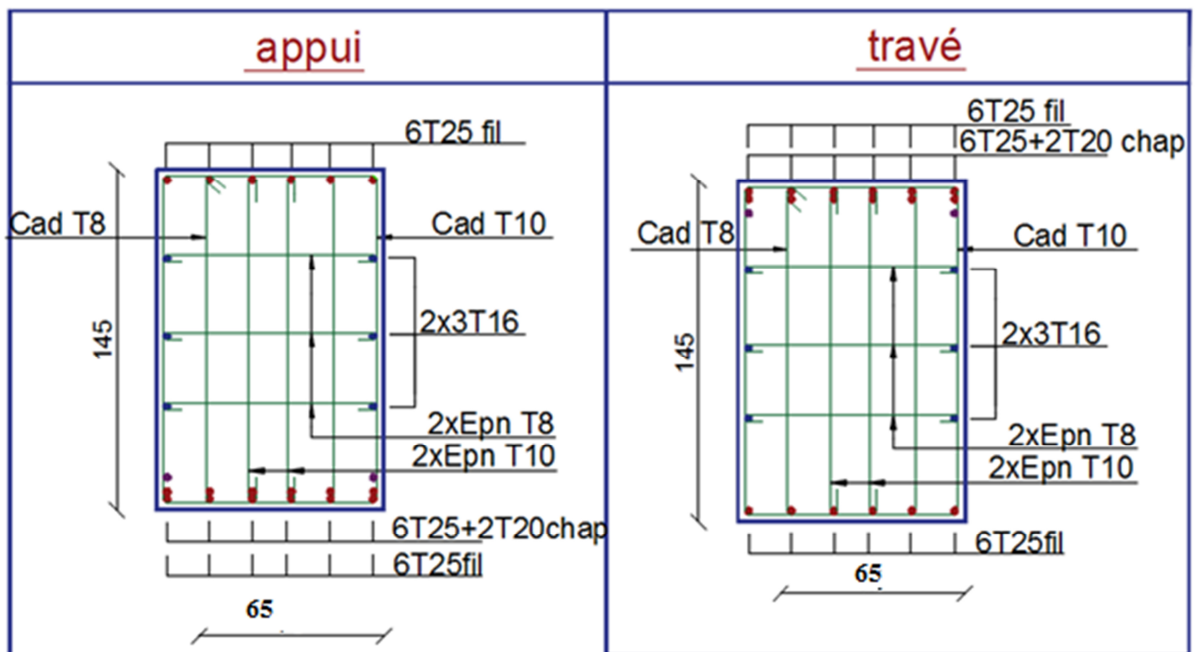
Ferraillage des poutres nervures sens transversale.
